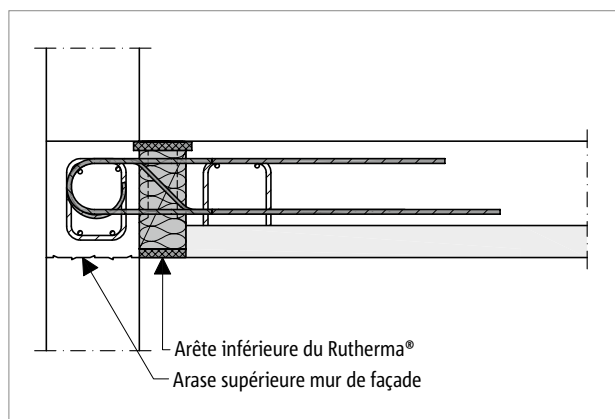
Schöck Rutherma® T type DF : plancher constitué de prédalles et façade en béton armé
